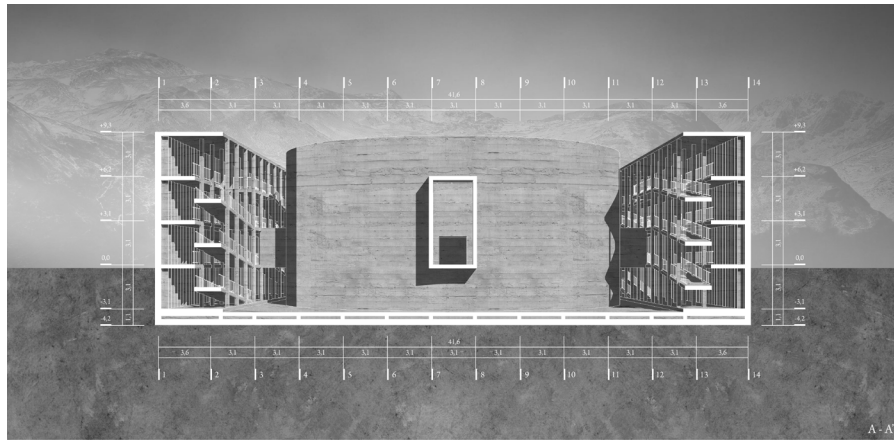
Secciones de la propuesta. Fuente: elaboración propia
